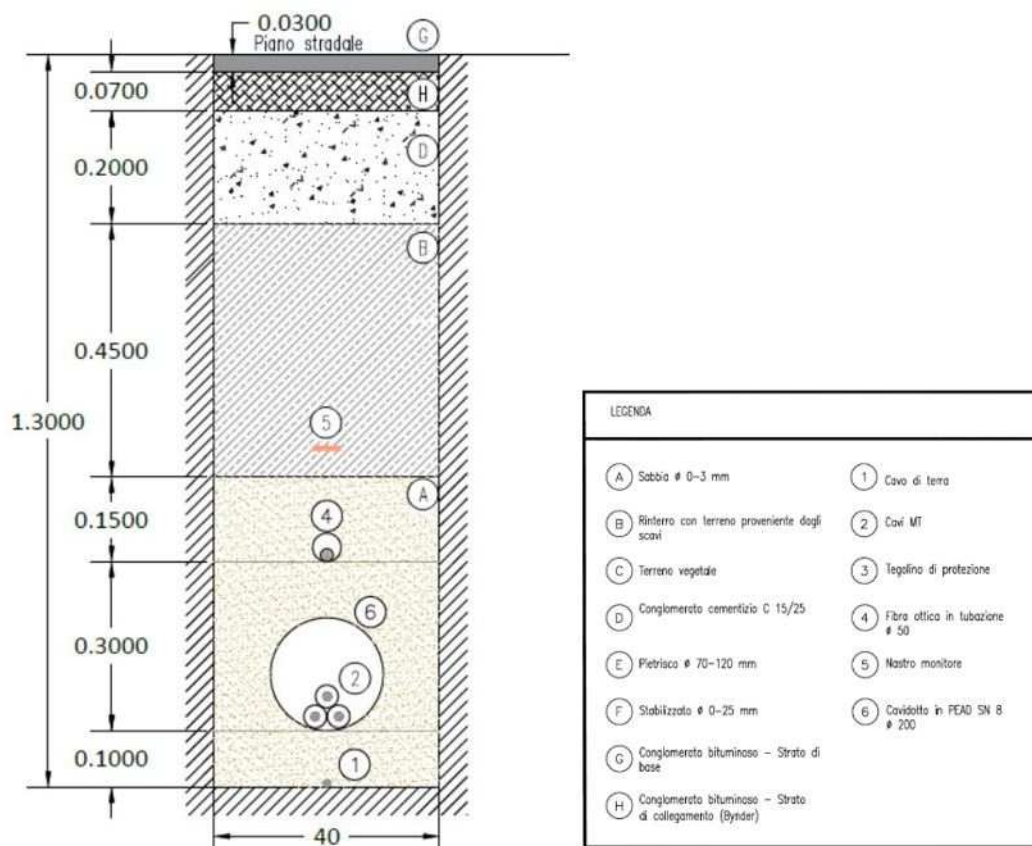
Sezione tipo del cavidotto su viabilità di progetto.
